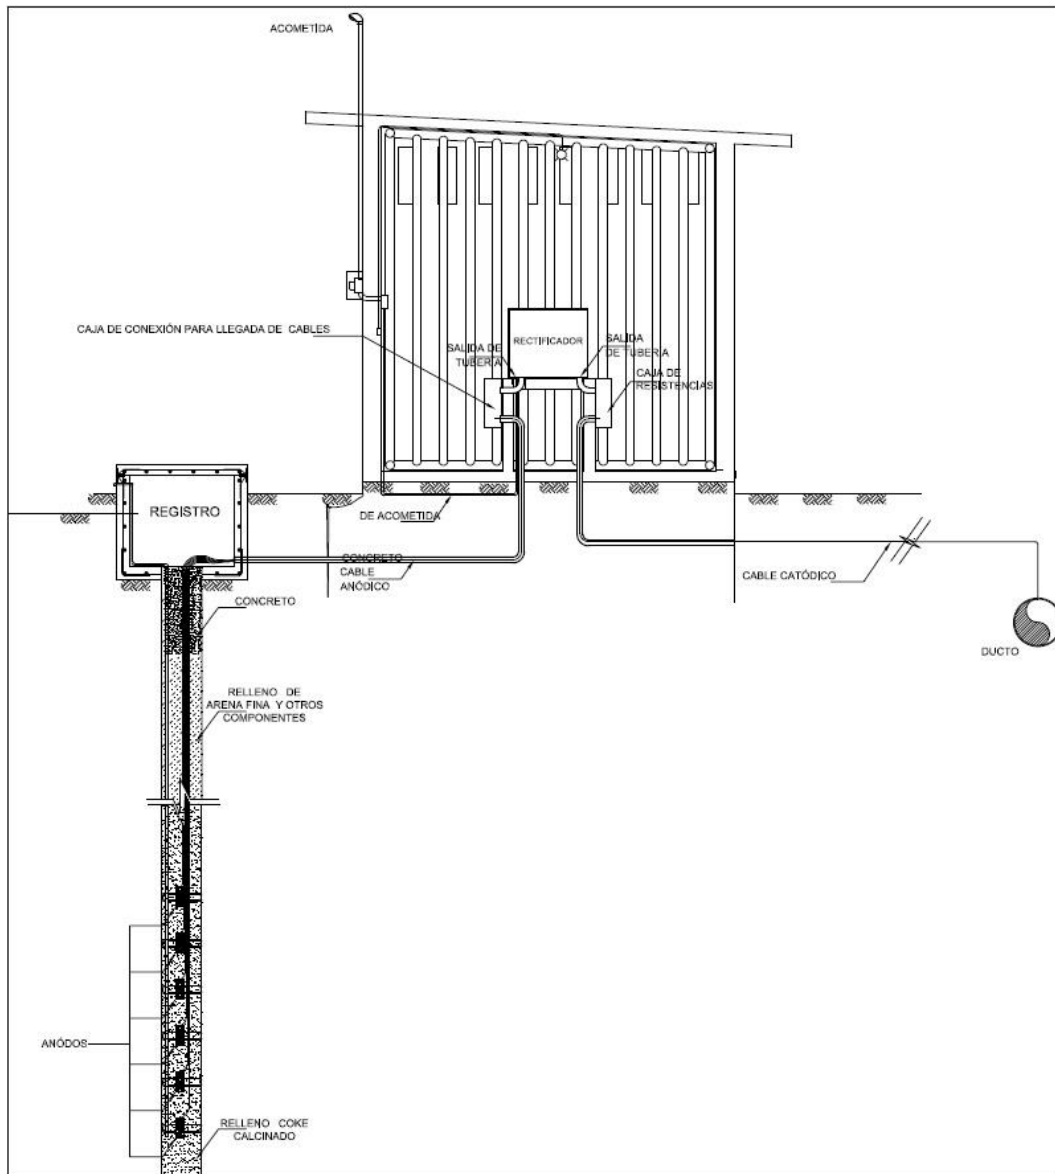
<sup>8</sup>. Esquema tipo de un sistema de protección catódica con corriente impresa en pozo profundo.
